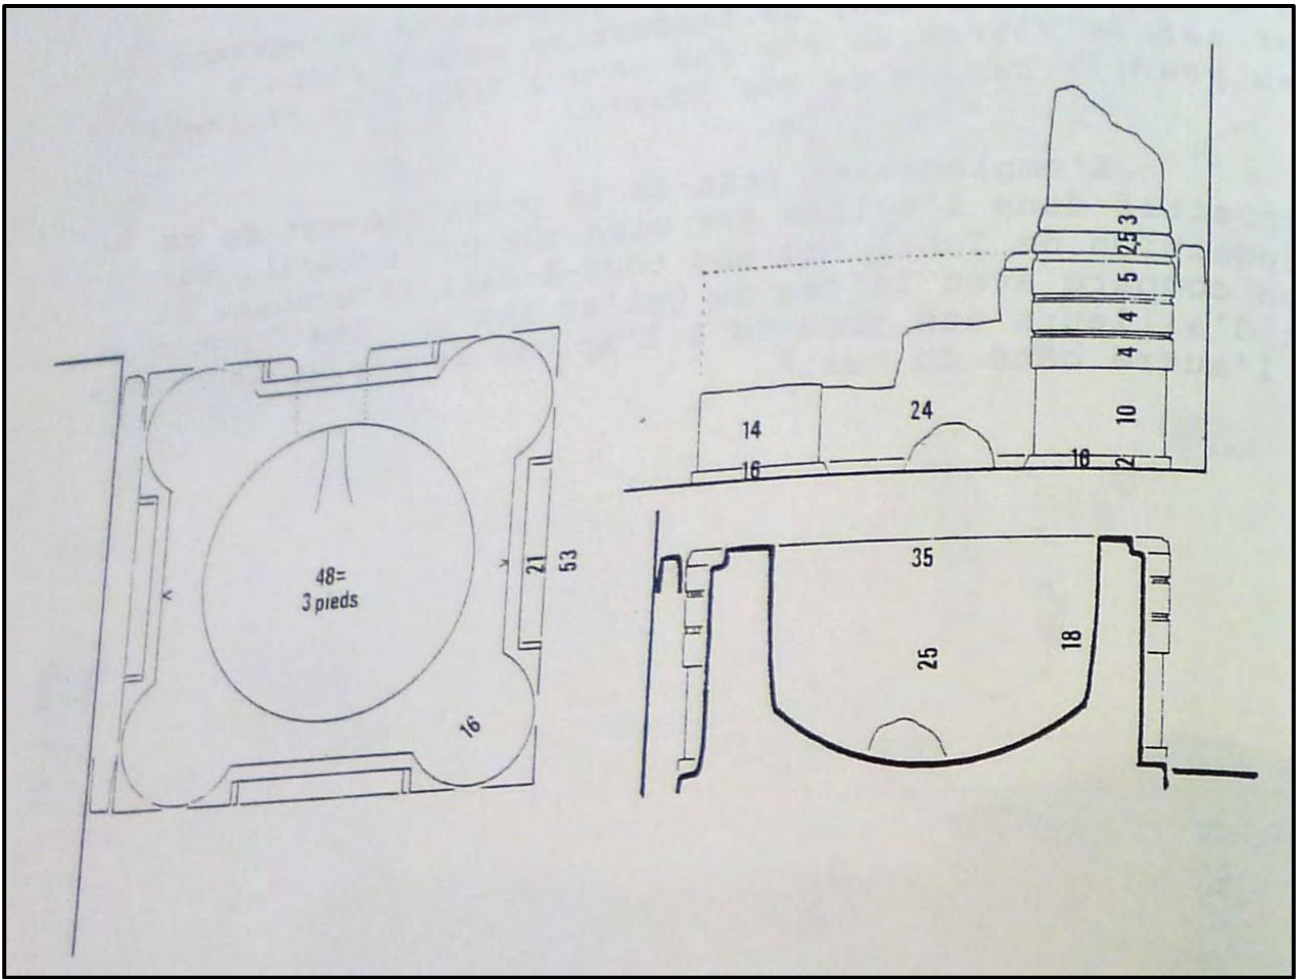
Qal'at Sem'an 2. Pianta e sezioni del fonte battesimale (Dufay 1984, I, Tav. 135.1).
